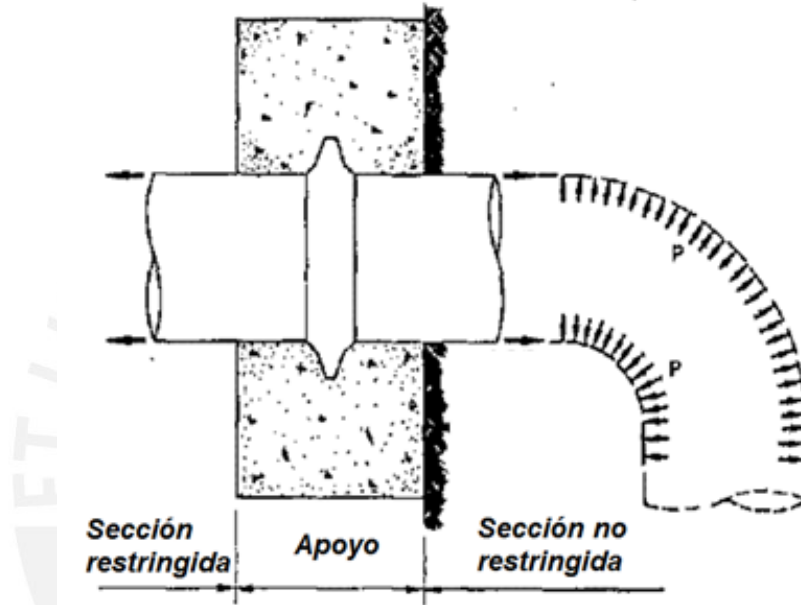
Esquema de un apoyo en una tubería enterrada
